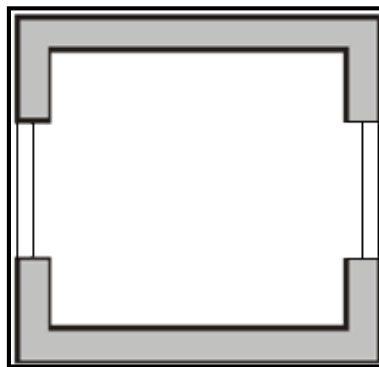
Exemple d'un éclairage bilatéral²⁵
